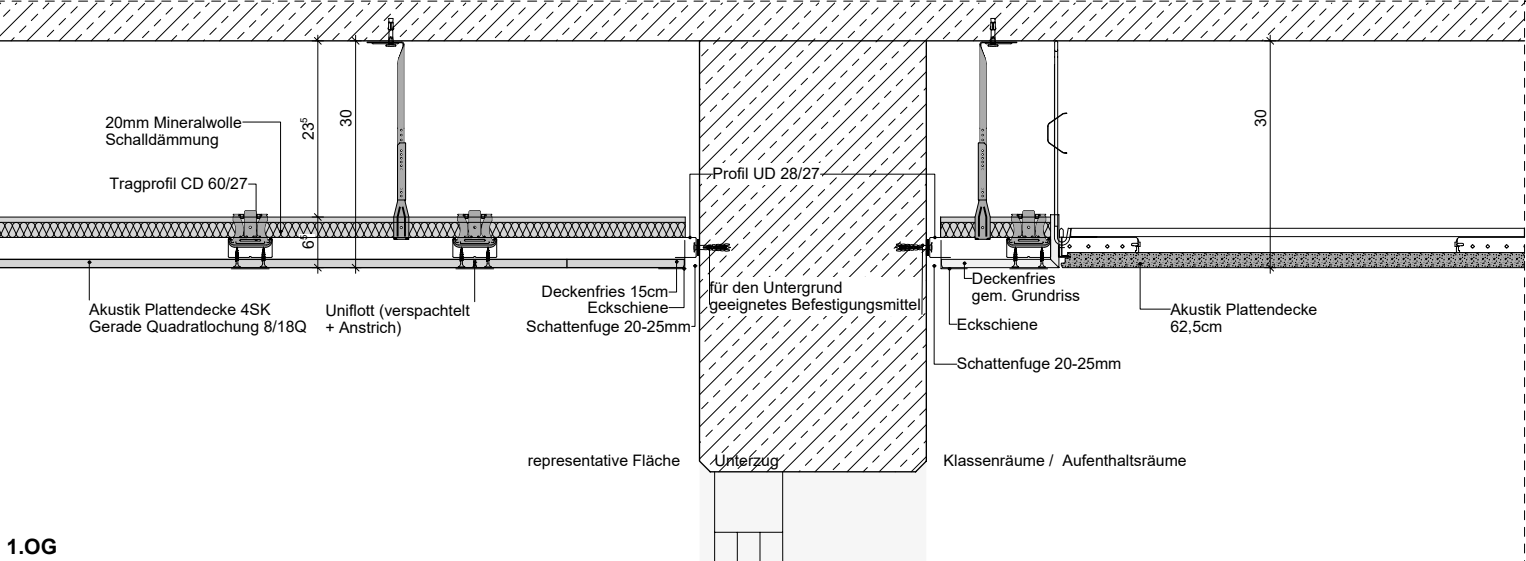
Decke 1 - gleitender Anschluss Unterzug
